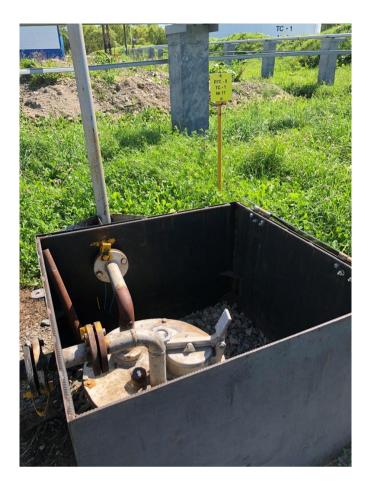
Общий вид резервуара РГС-5 зав.№ 17
